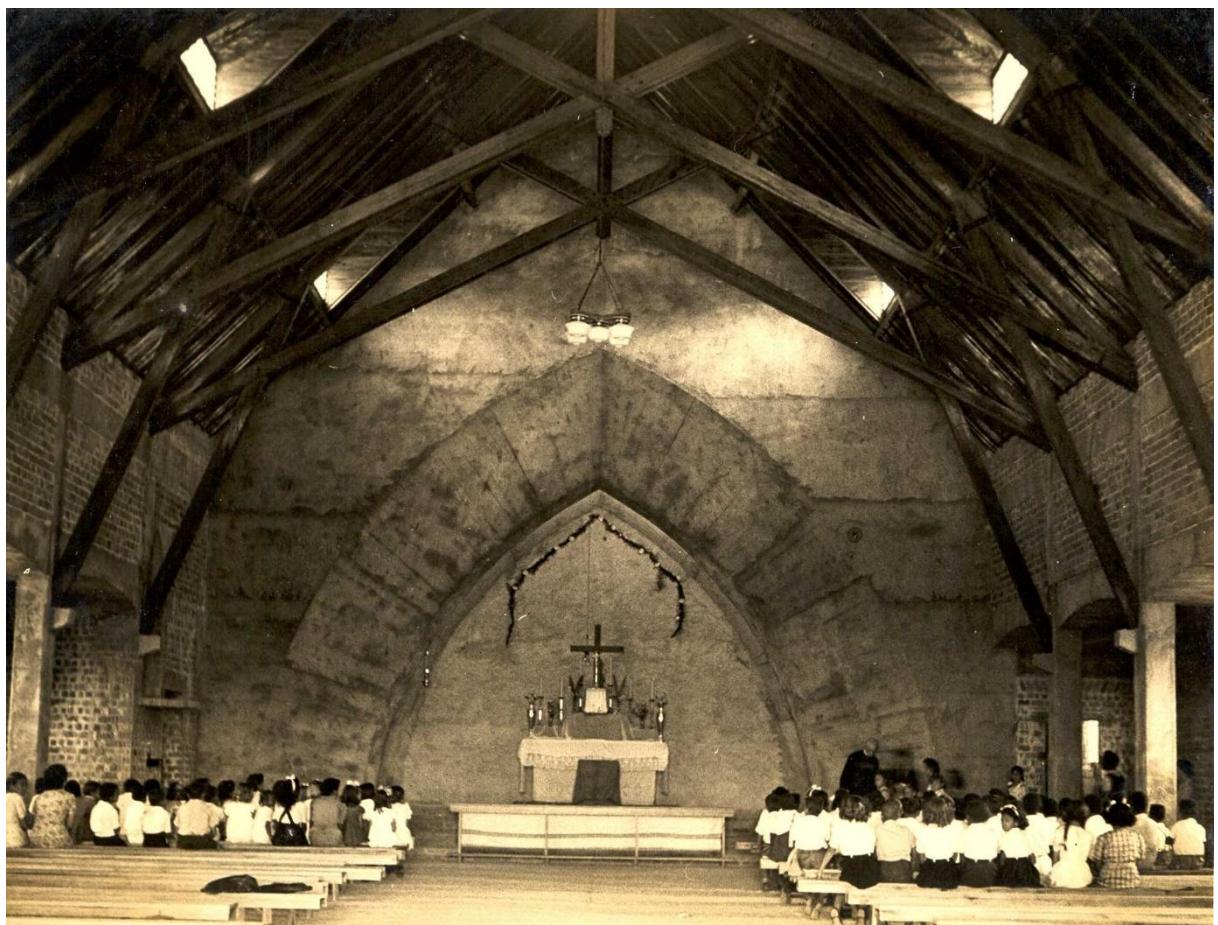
Igreja Santa Cecília, fotografia da primeira missa, em 1943 – com a igreja ainda em construção. Fonte: Acervo IPPU.
